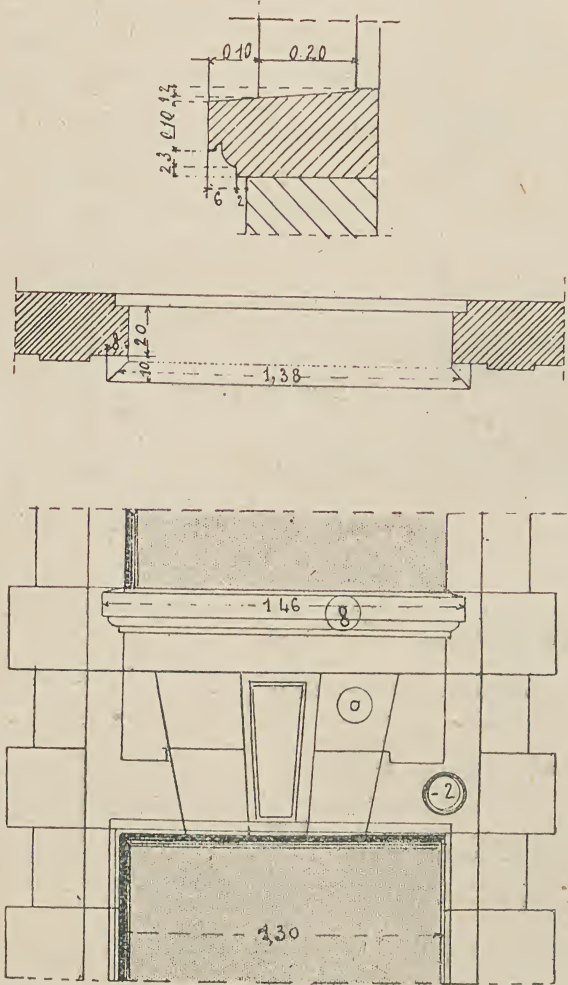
et 69. — Coupe, plan et élévation de l'appui en pierre, 5^e étage.
